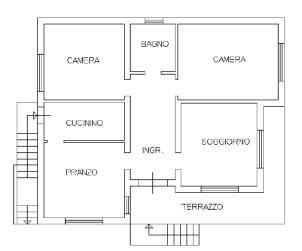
Estratto planimetria catastale, relativa al piano rialzato
